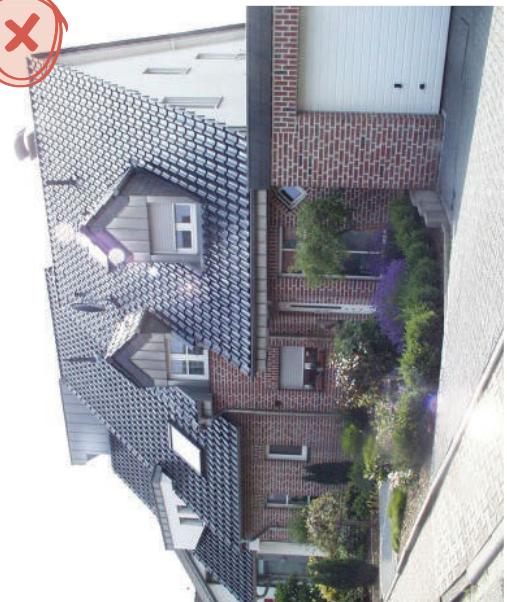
störende Reflexionen durch glasierte Dachdeckung
